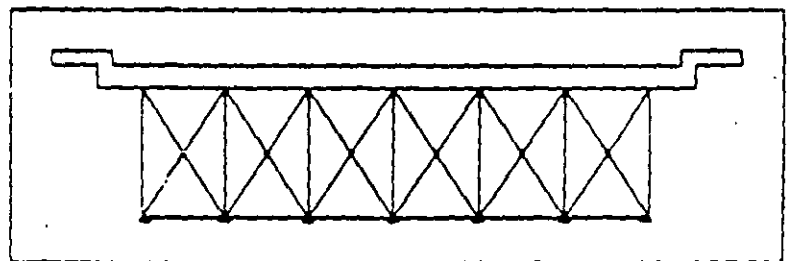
Sección transversal, tipo 20, Losa sobre Armadura Espacial
